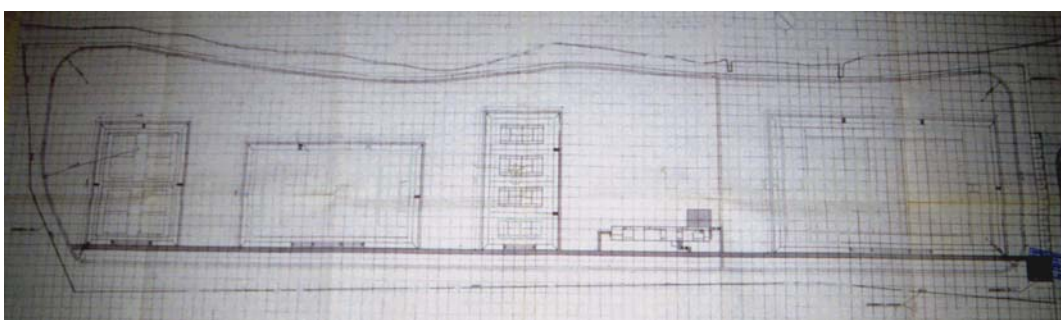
Recinto Deportivo de Salas Bajas: ordenación de pistas, por I. y J. Vicente García, marzo 1988.
